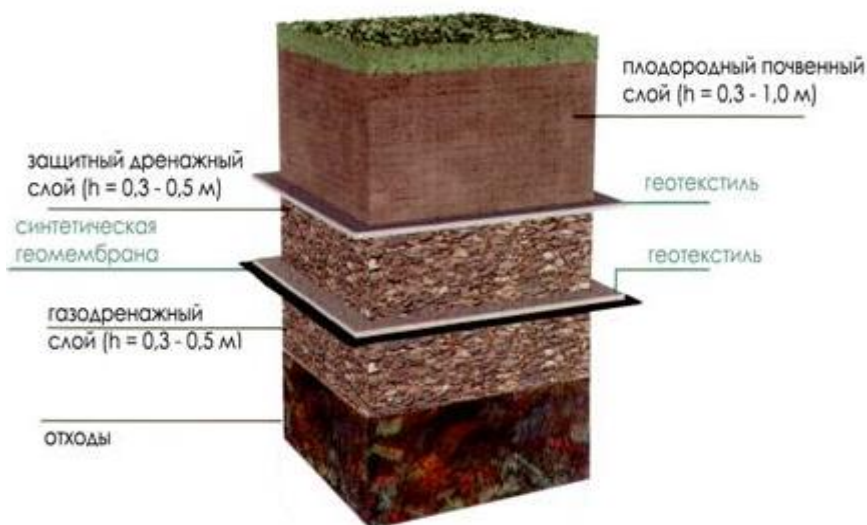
Финальное перекрытие поверхности полигона с использованием геомембраны и геотекстиля.
